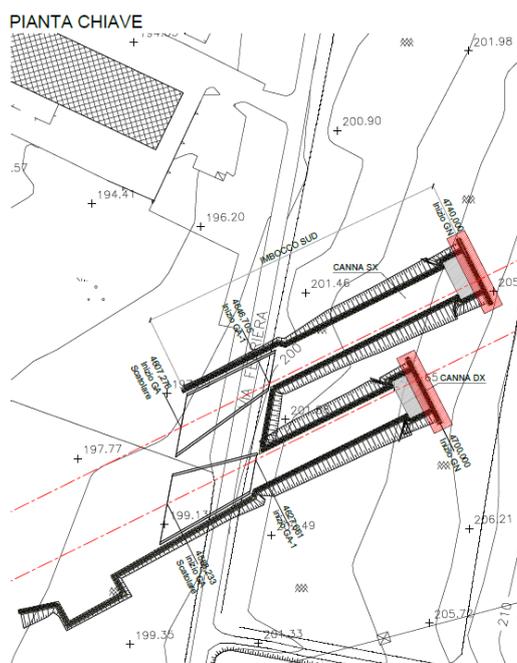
Planimetria imbocco sud Madonna del Piano
